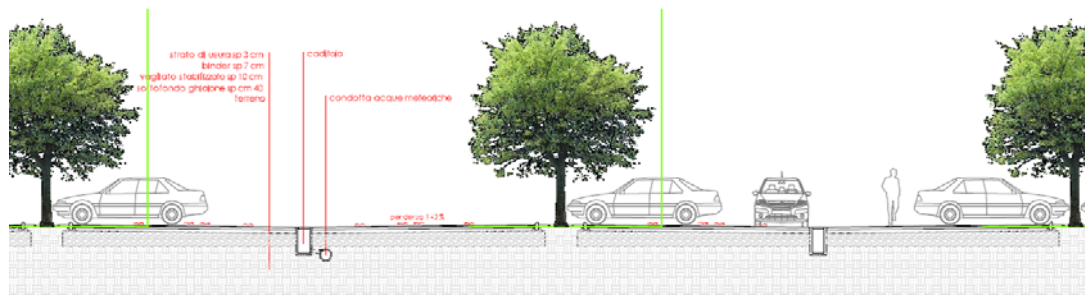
Sezione tipo della sistemazione a verde dell'area di sosta.
